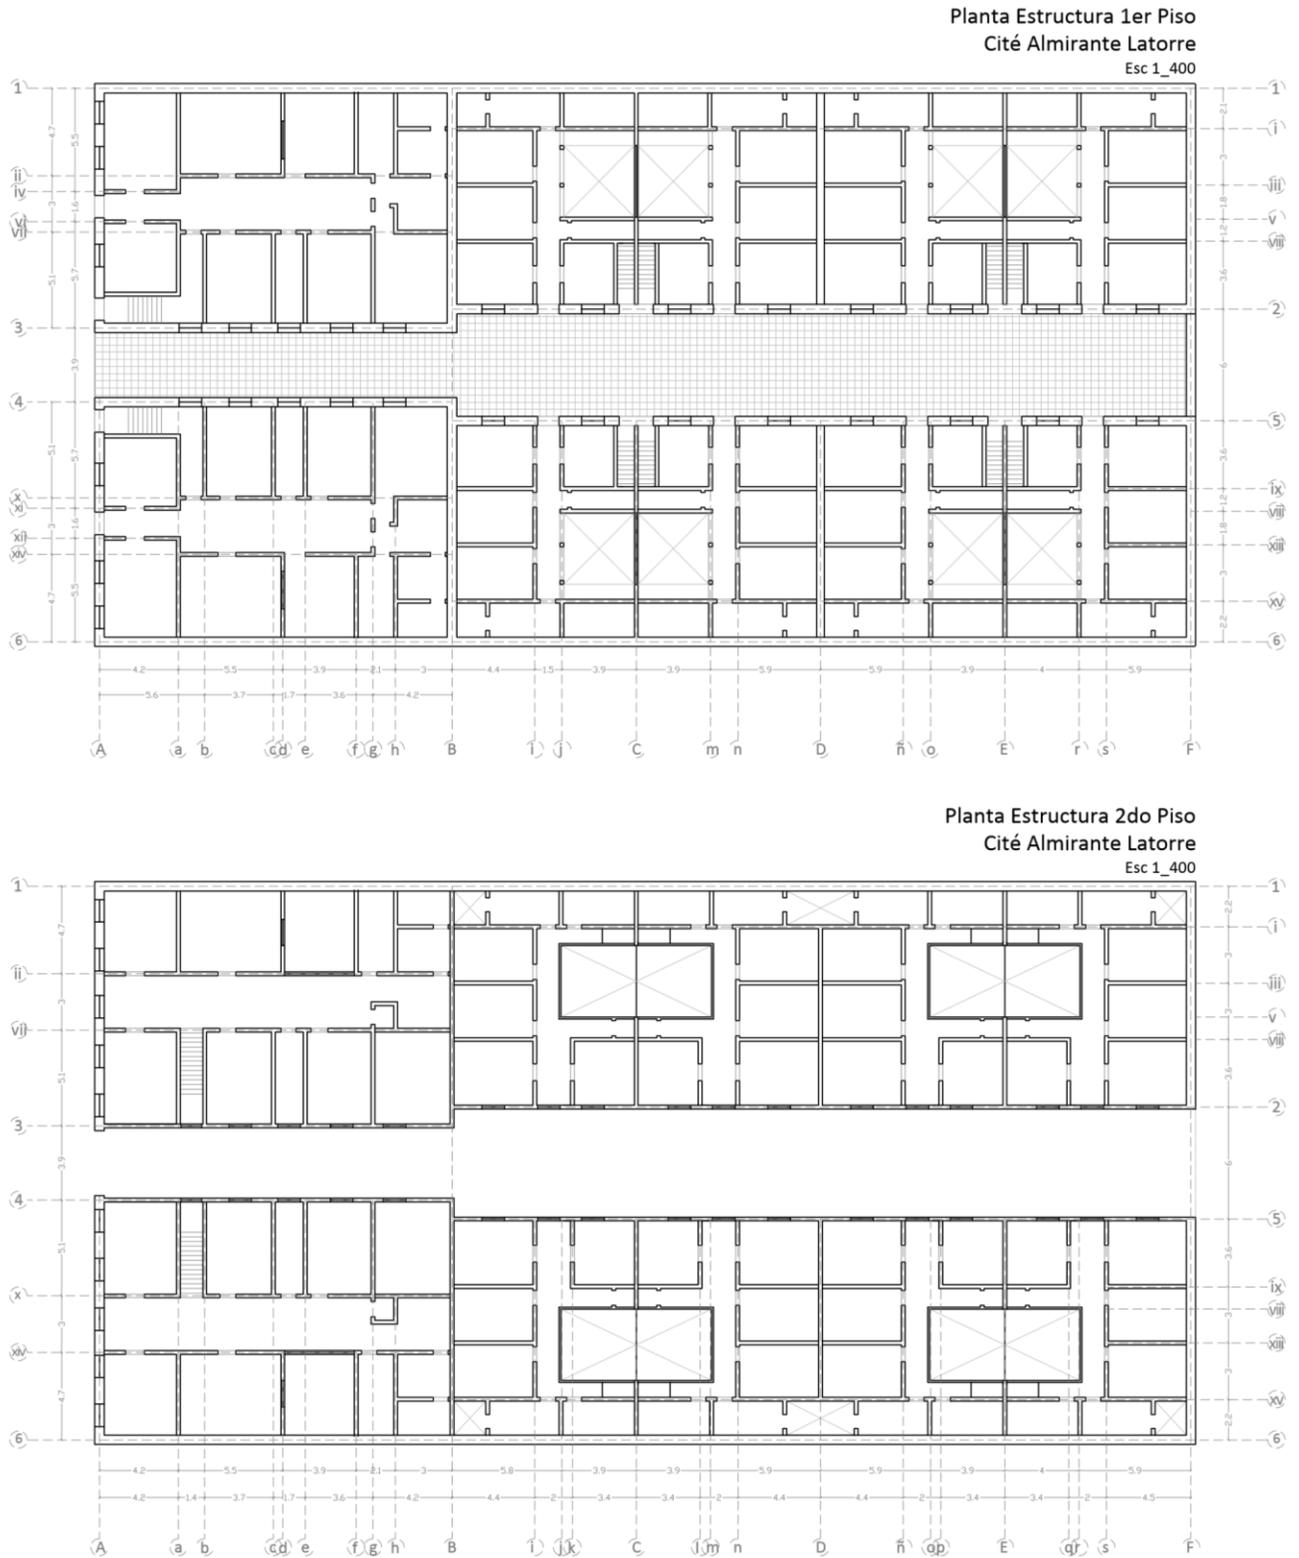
Planta Estructura 1er y 2do piso Cité Almirante Latorre.
